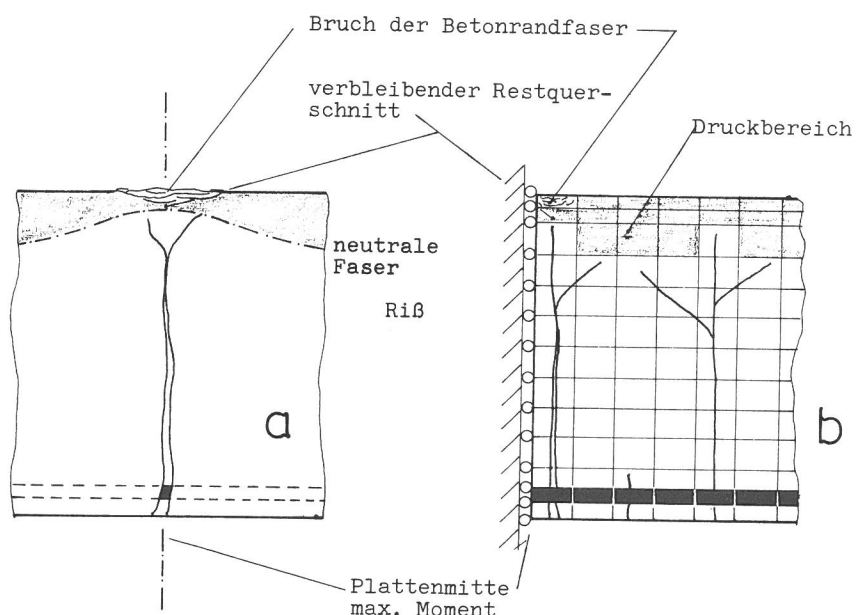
Ausbildung einer Betonbrücke im Druckquerschnitt vor dem Bruch
